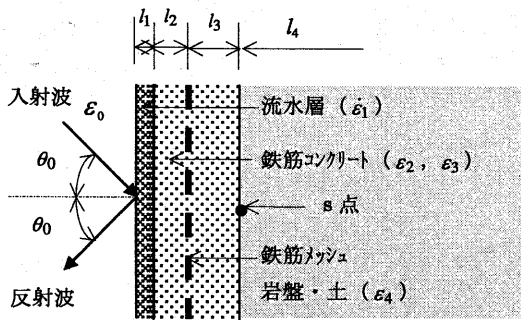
多層構造トンネル壁 (Multi-layer-structure Tunnel Wall)
